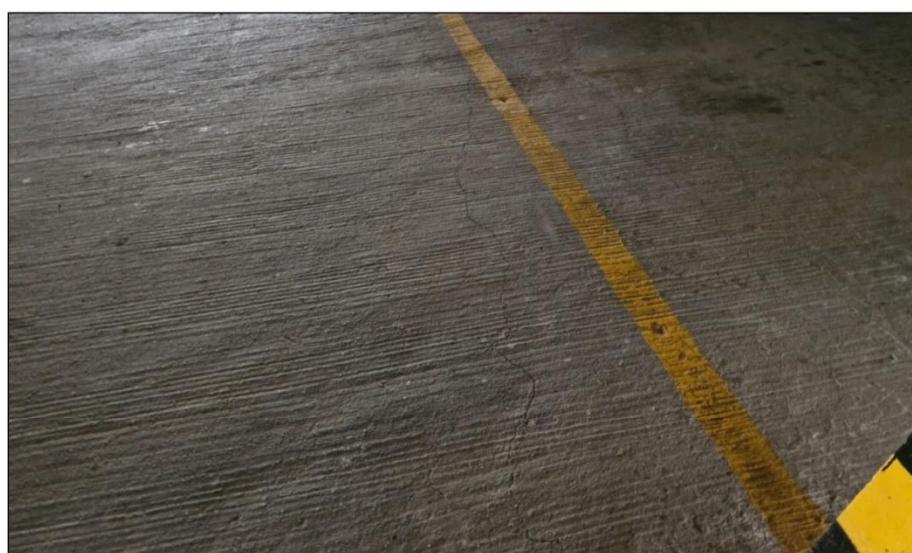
Fisuras en la parte superior de la losa de entrepiso de parqueaderos
